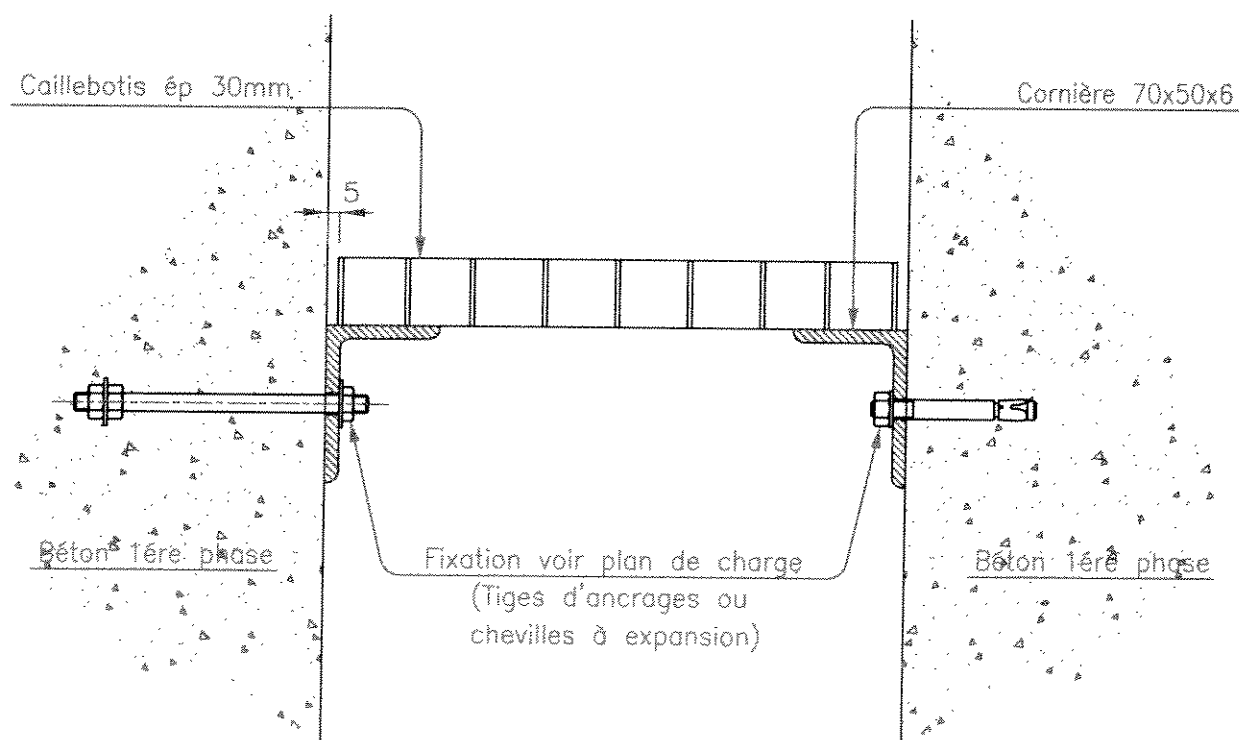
PLATELAGE – BORDURE EN CONSOLE SUR VOILE BETON
